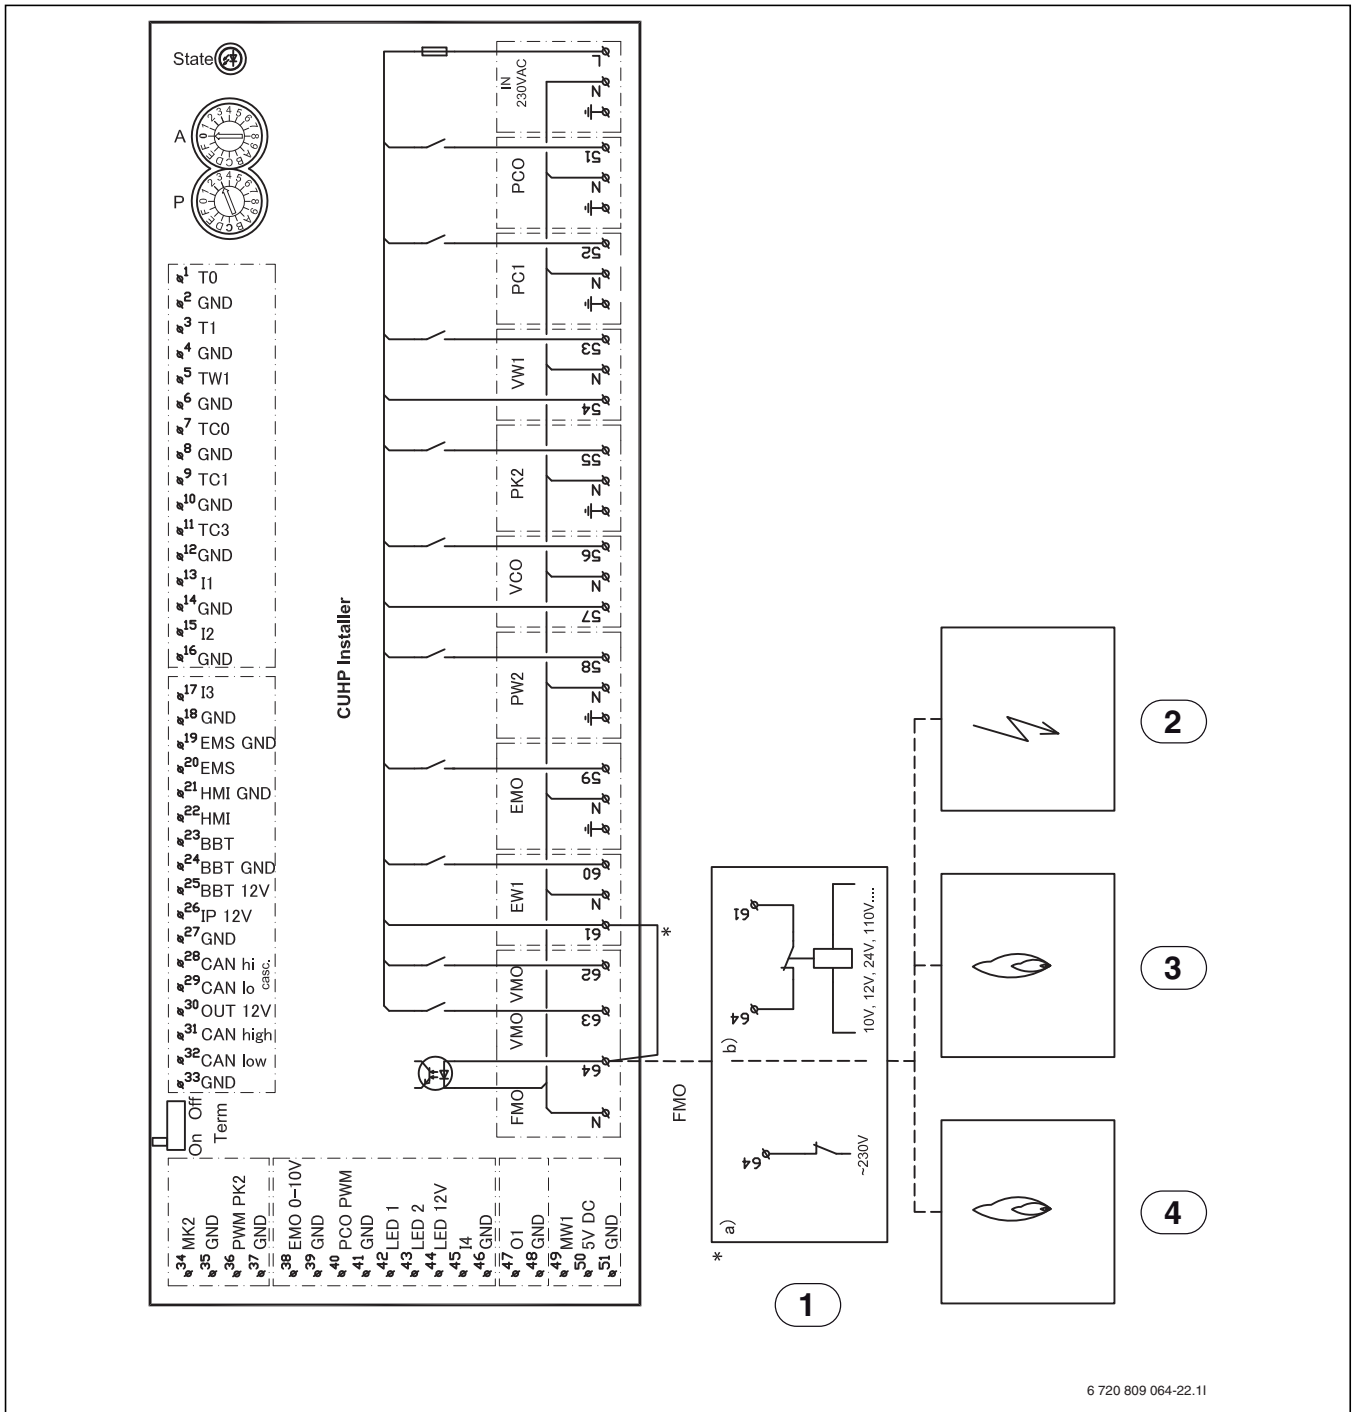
Schaltplan Installationsmodul, Alarm des externen Zuheizers
